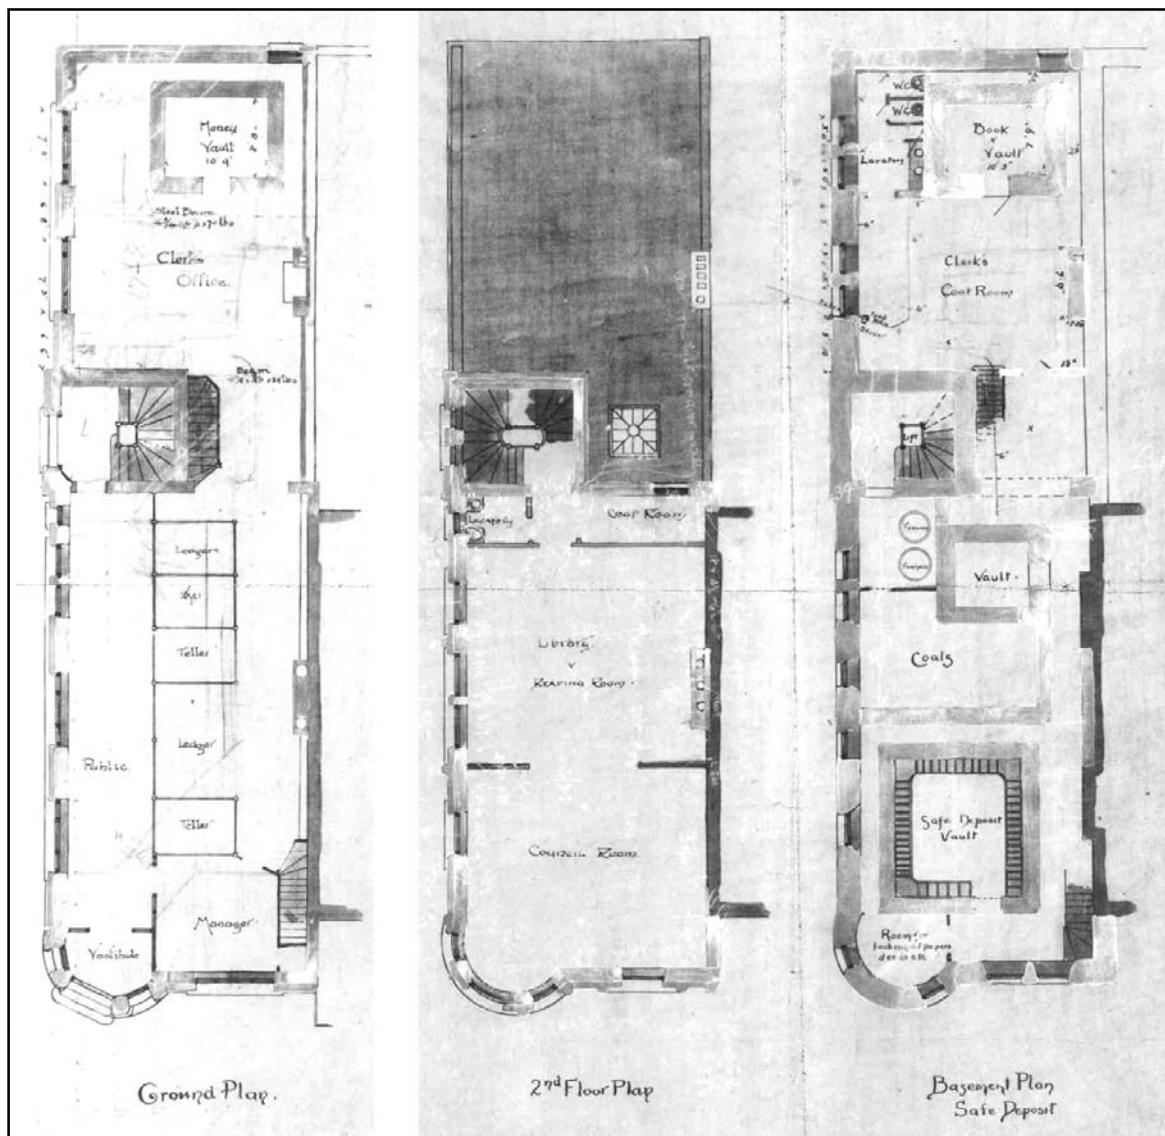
Plans du rez-de-chaussée, du deuxième étage et du sous-sol de la West End Branch
